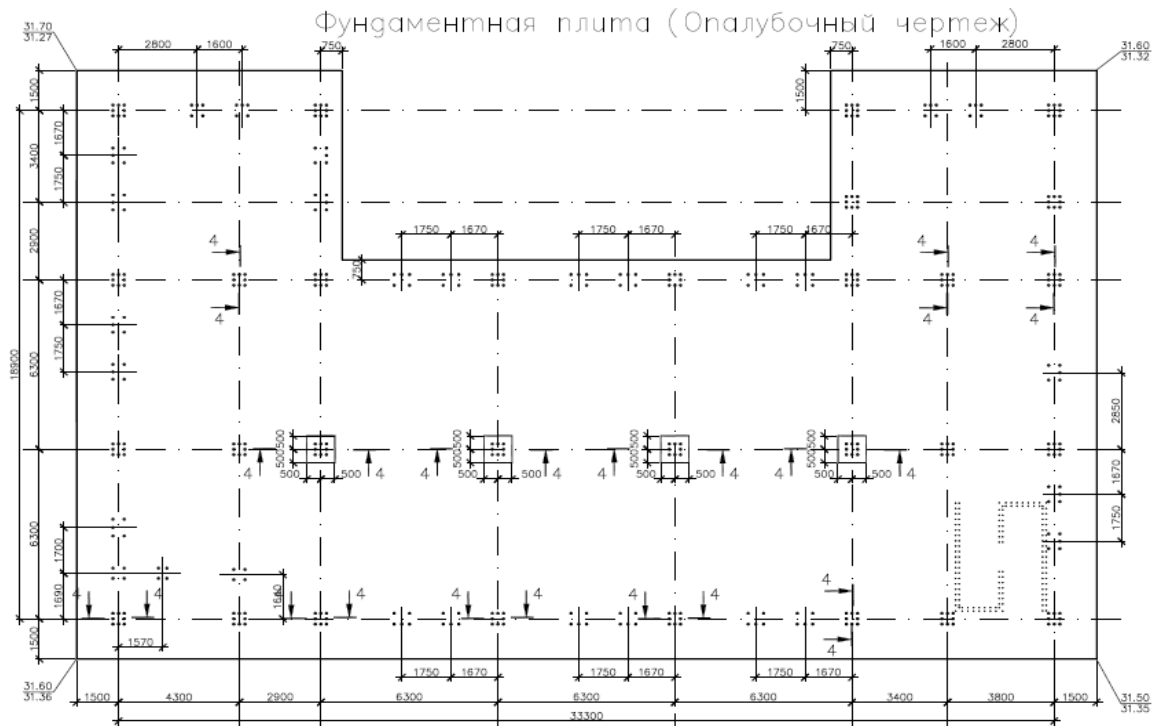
Опалубочный чертеж фундаментной плиты
